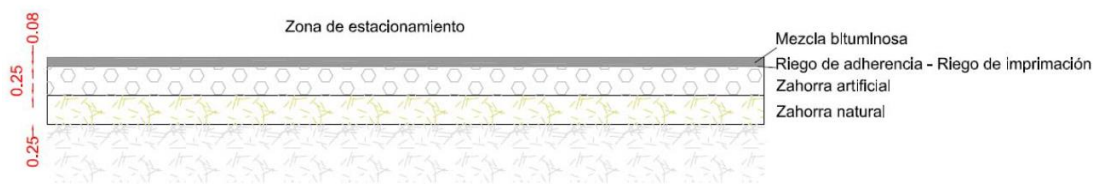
Dimensionamiento de firme para la zona de estacionamiento.
